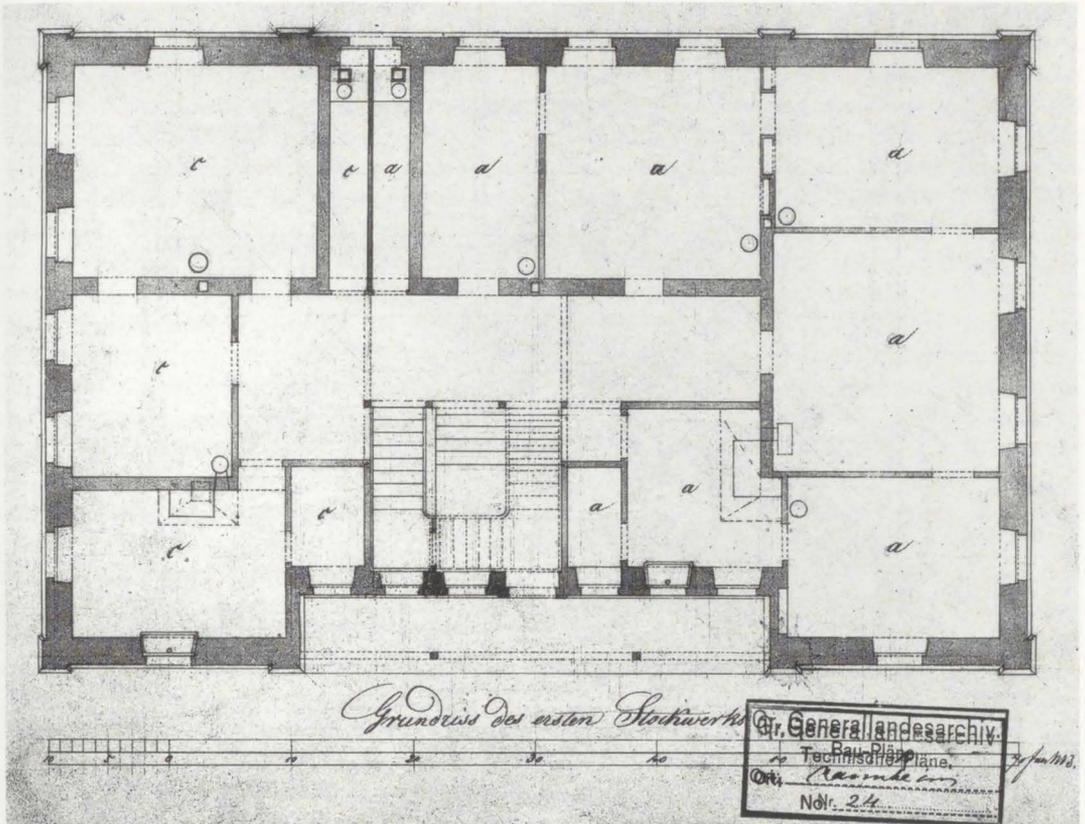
Beamtenwohnhaus, bez. „Entwurf zu den Beamtenwohnungen für je drei Familien./Grundriss des ersten Stockwerks.“ GLA, G Mannheim! 24.
